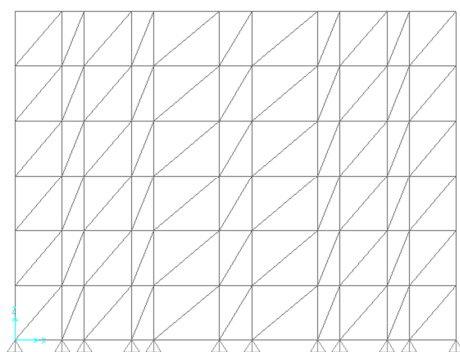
Configuração dos Planos de Contraventamento Vertical Com Elementos de Contraventamento Pequenos
